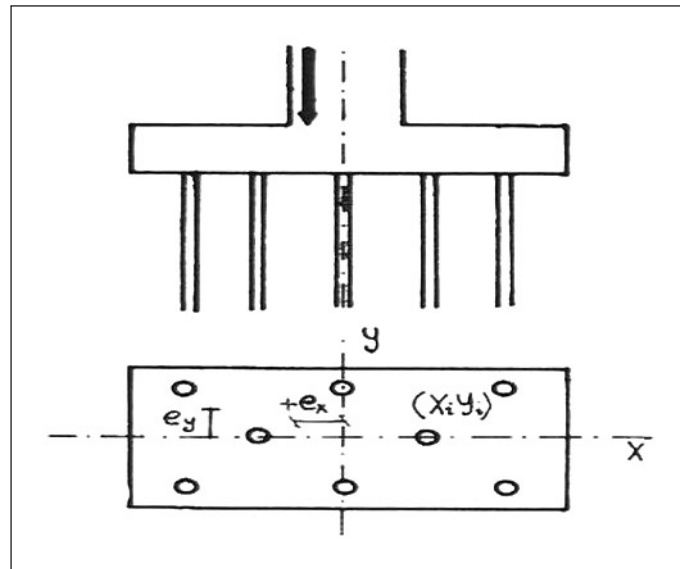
CIMENTACIÓN MEDIANTE PILOTES EN PILAS.
